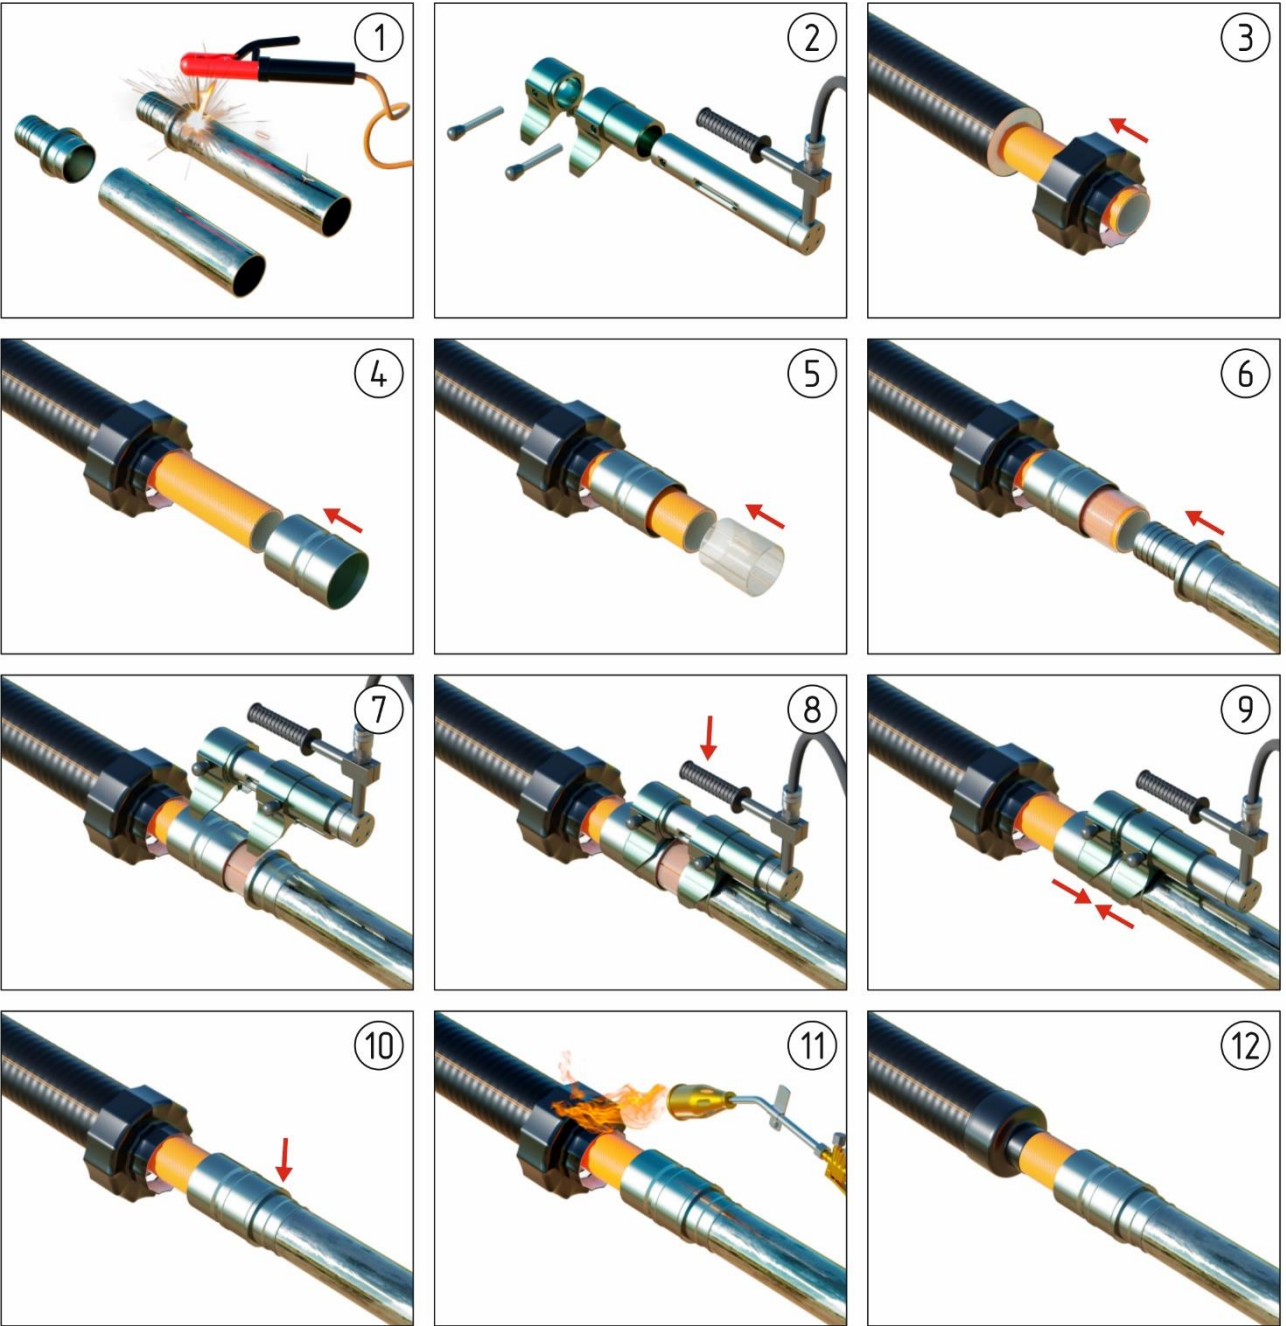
Порядок монтажа пресс-фитинга с ПВ под сварку
